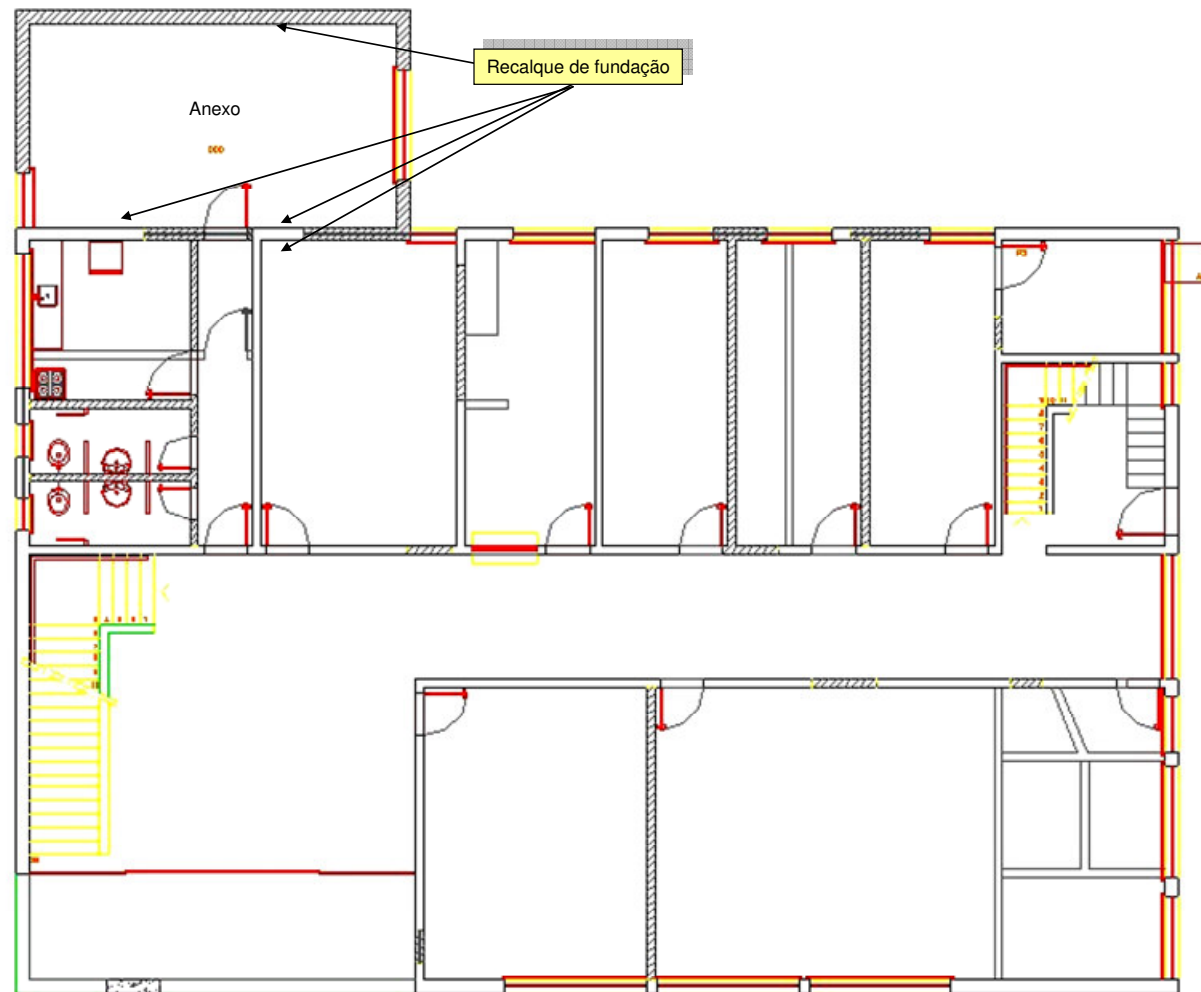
Planta do 1º pavimento e suas patologias.
